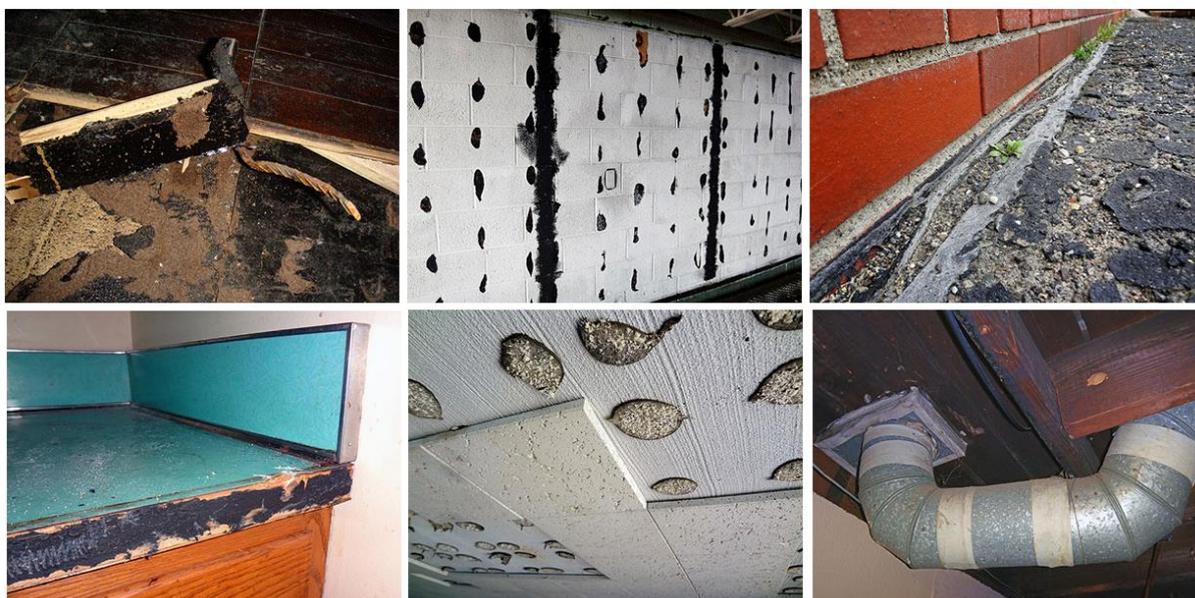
Utilização de amianto em adesivos e colas para diversas aplicações
